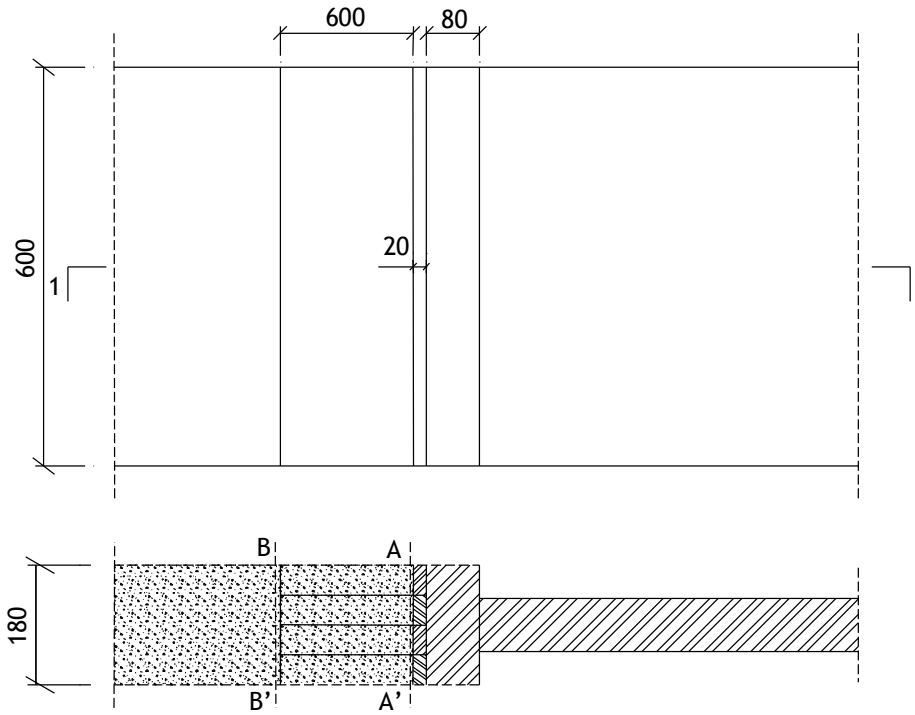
Alçado e corte horizontal de um módulo da zona de transição do nó metálico de ligação para a escora de cantaria.
